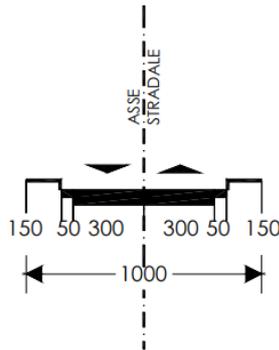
Estratto del DM 5/11/2001 con individuazione categoria stradale
